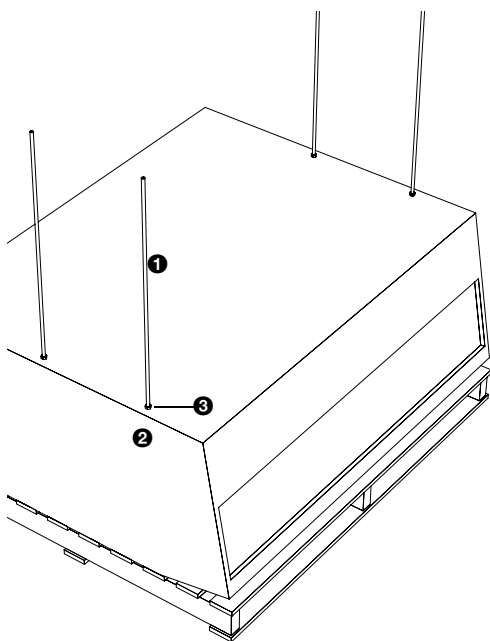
Befestigung der Gewindestangen am Gerät
